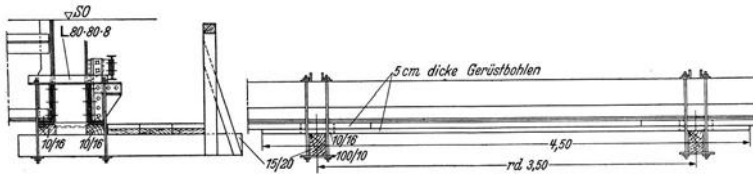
Hängerüstung (an einen bestehenden Gurt angeklemt).
